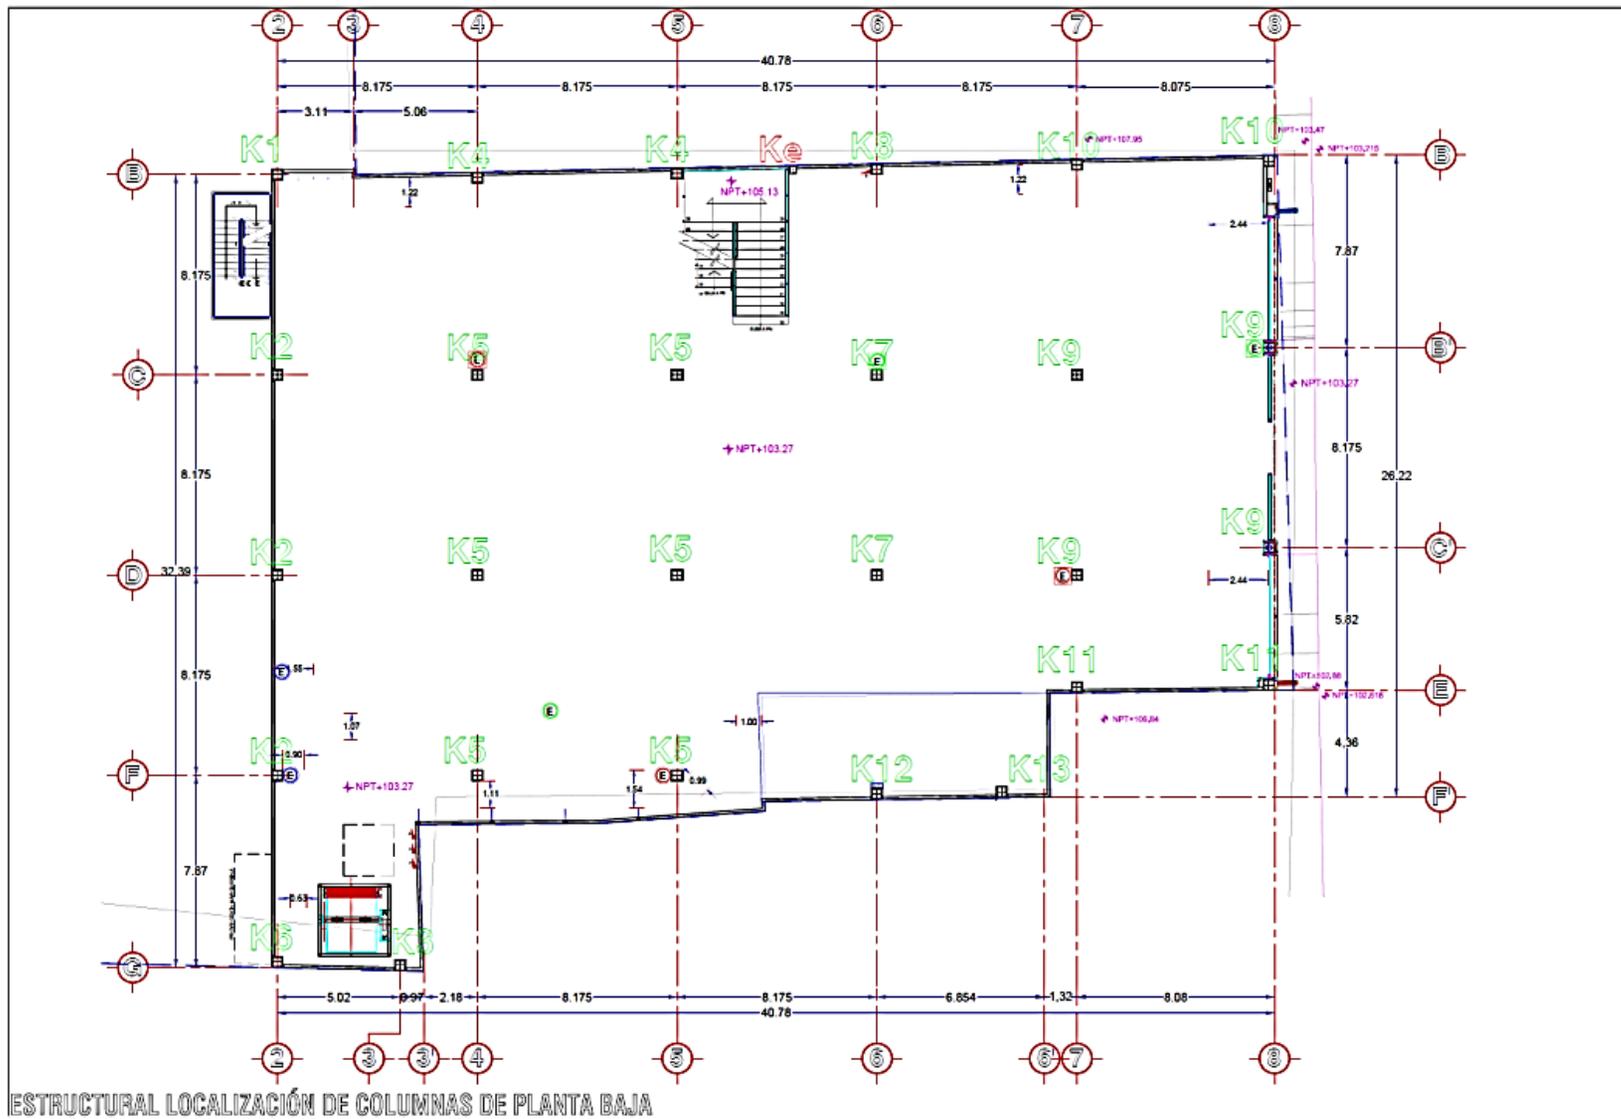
Plano de localización de los tipos de columnas según su armado en planta baja.
